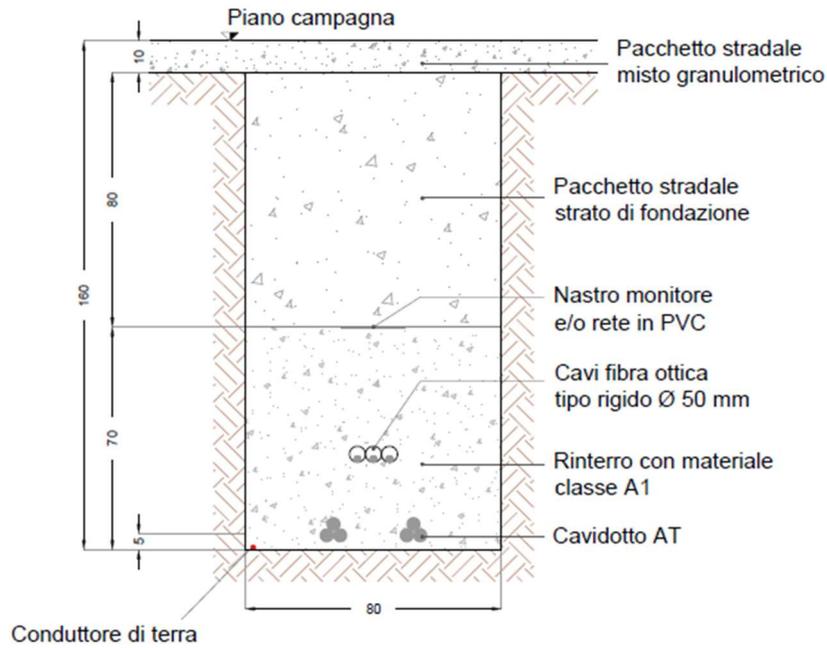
Sezione tipo cavidotto AT una terna su strada sterrata
